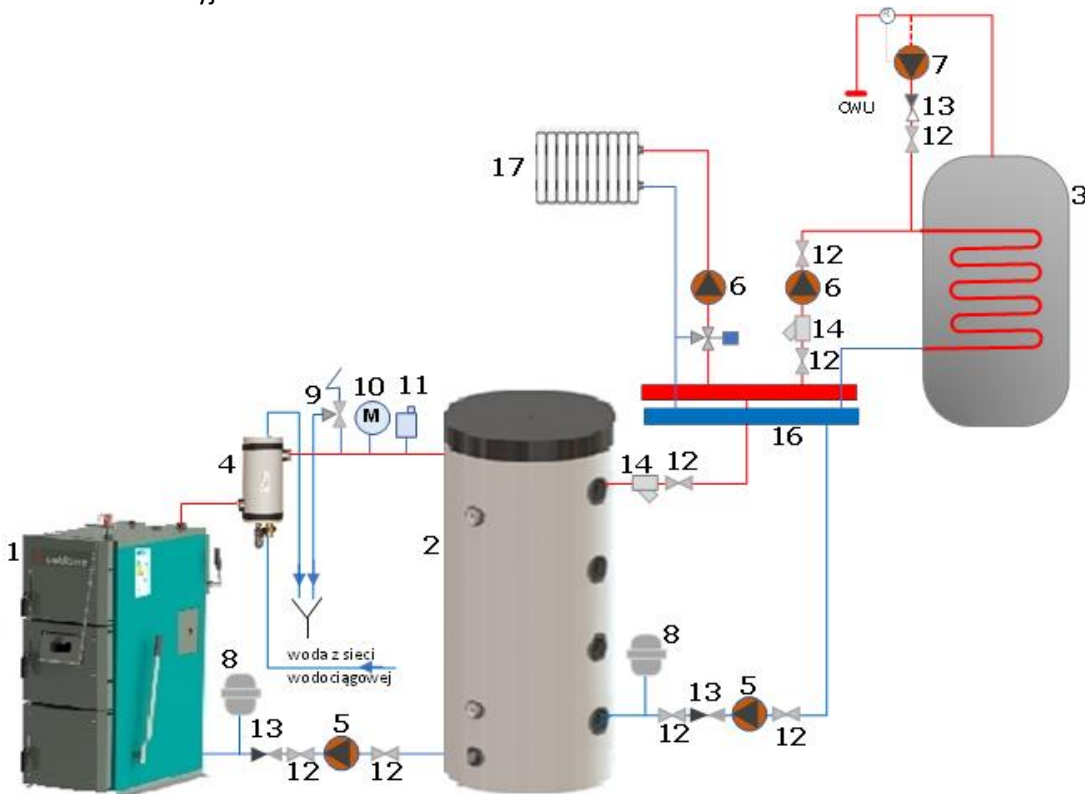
Przykład obejścia grawitacyjnego pompy obiegowej dla odprowadzenia nadmiaru ciepła w przypadku zaniku prądu
